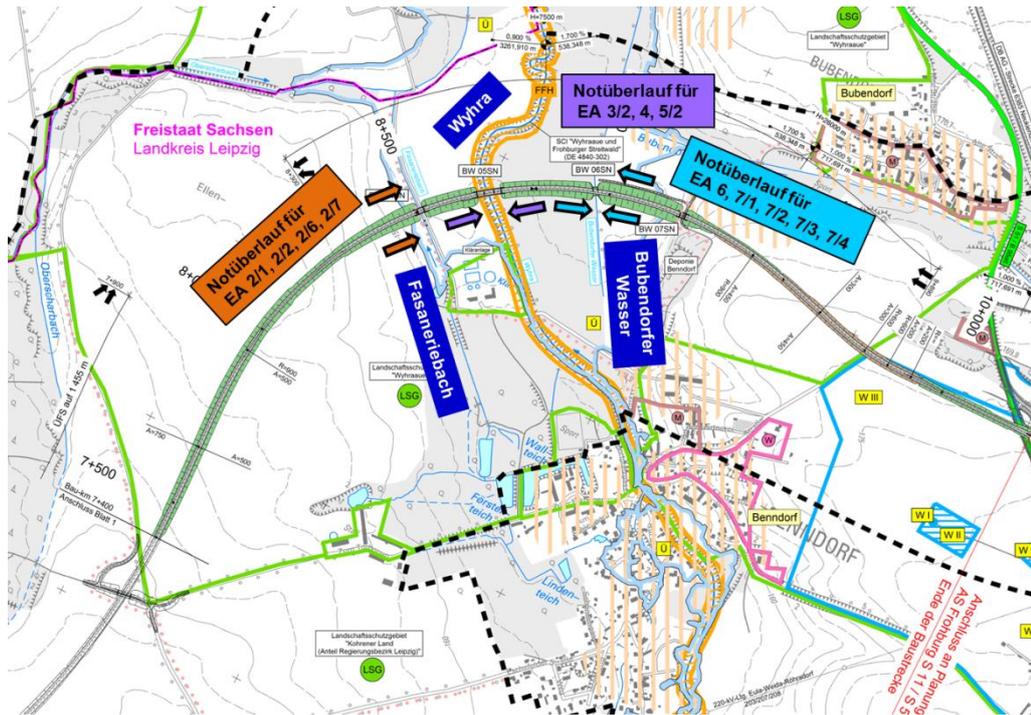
Potenziell betroffene Oberflächenwasserkörper im trassennahen Bereich des Planungsvorhabens (verändert nach DELTA-PLAN 2018b)
